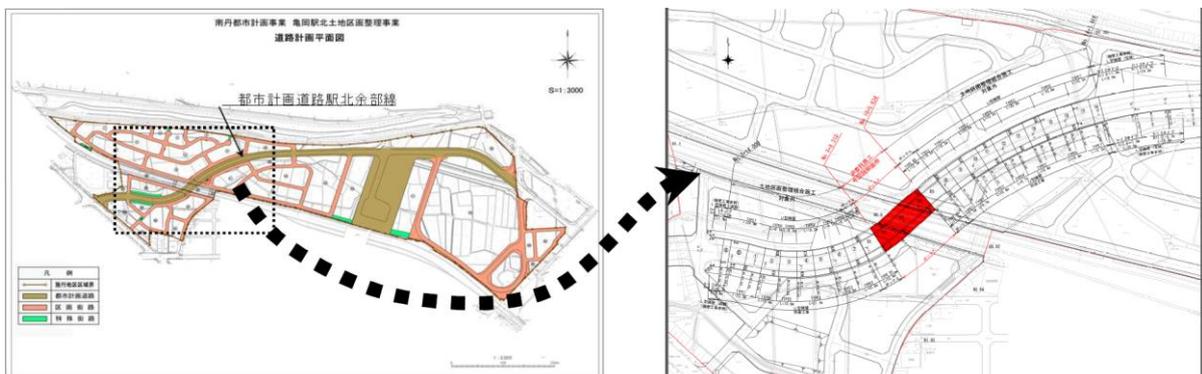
亀岡駅北土地区画整理事業道路位置図及び JR 軌道立体交差部計画平面図
